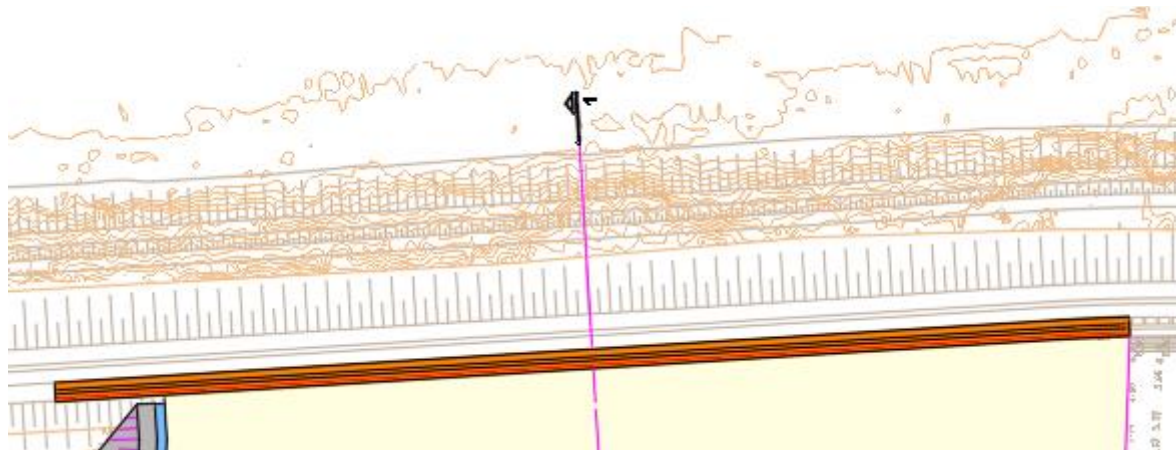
Implantação em planta do novo muro-cortina no Trecho A
